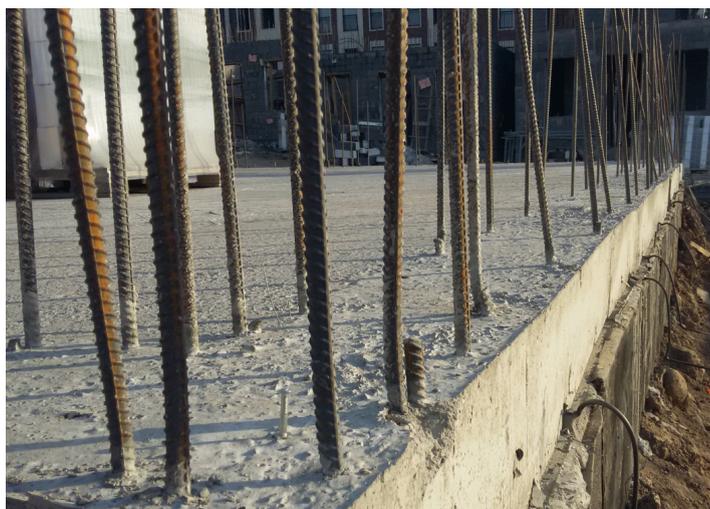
Общий вид фундаментной плиты с выпусками арматуры
